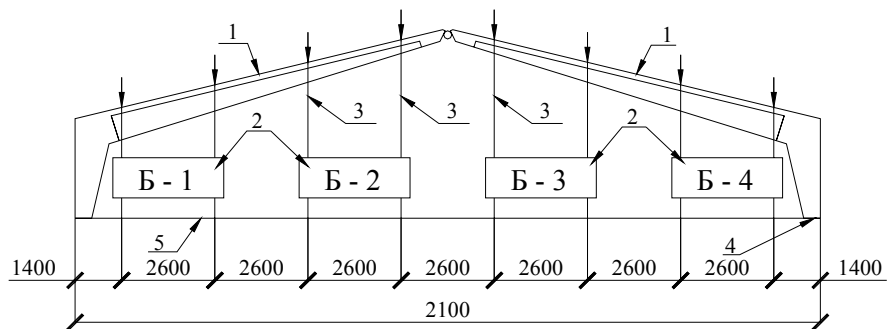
Схема стенду для досліджень рамних каркасів:
